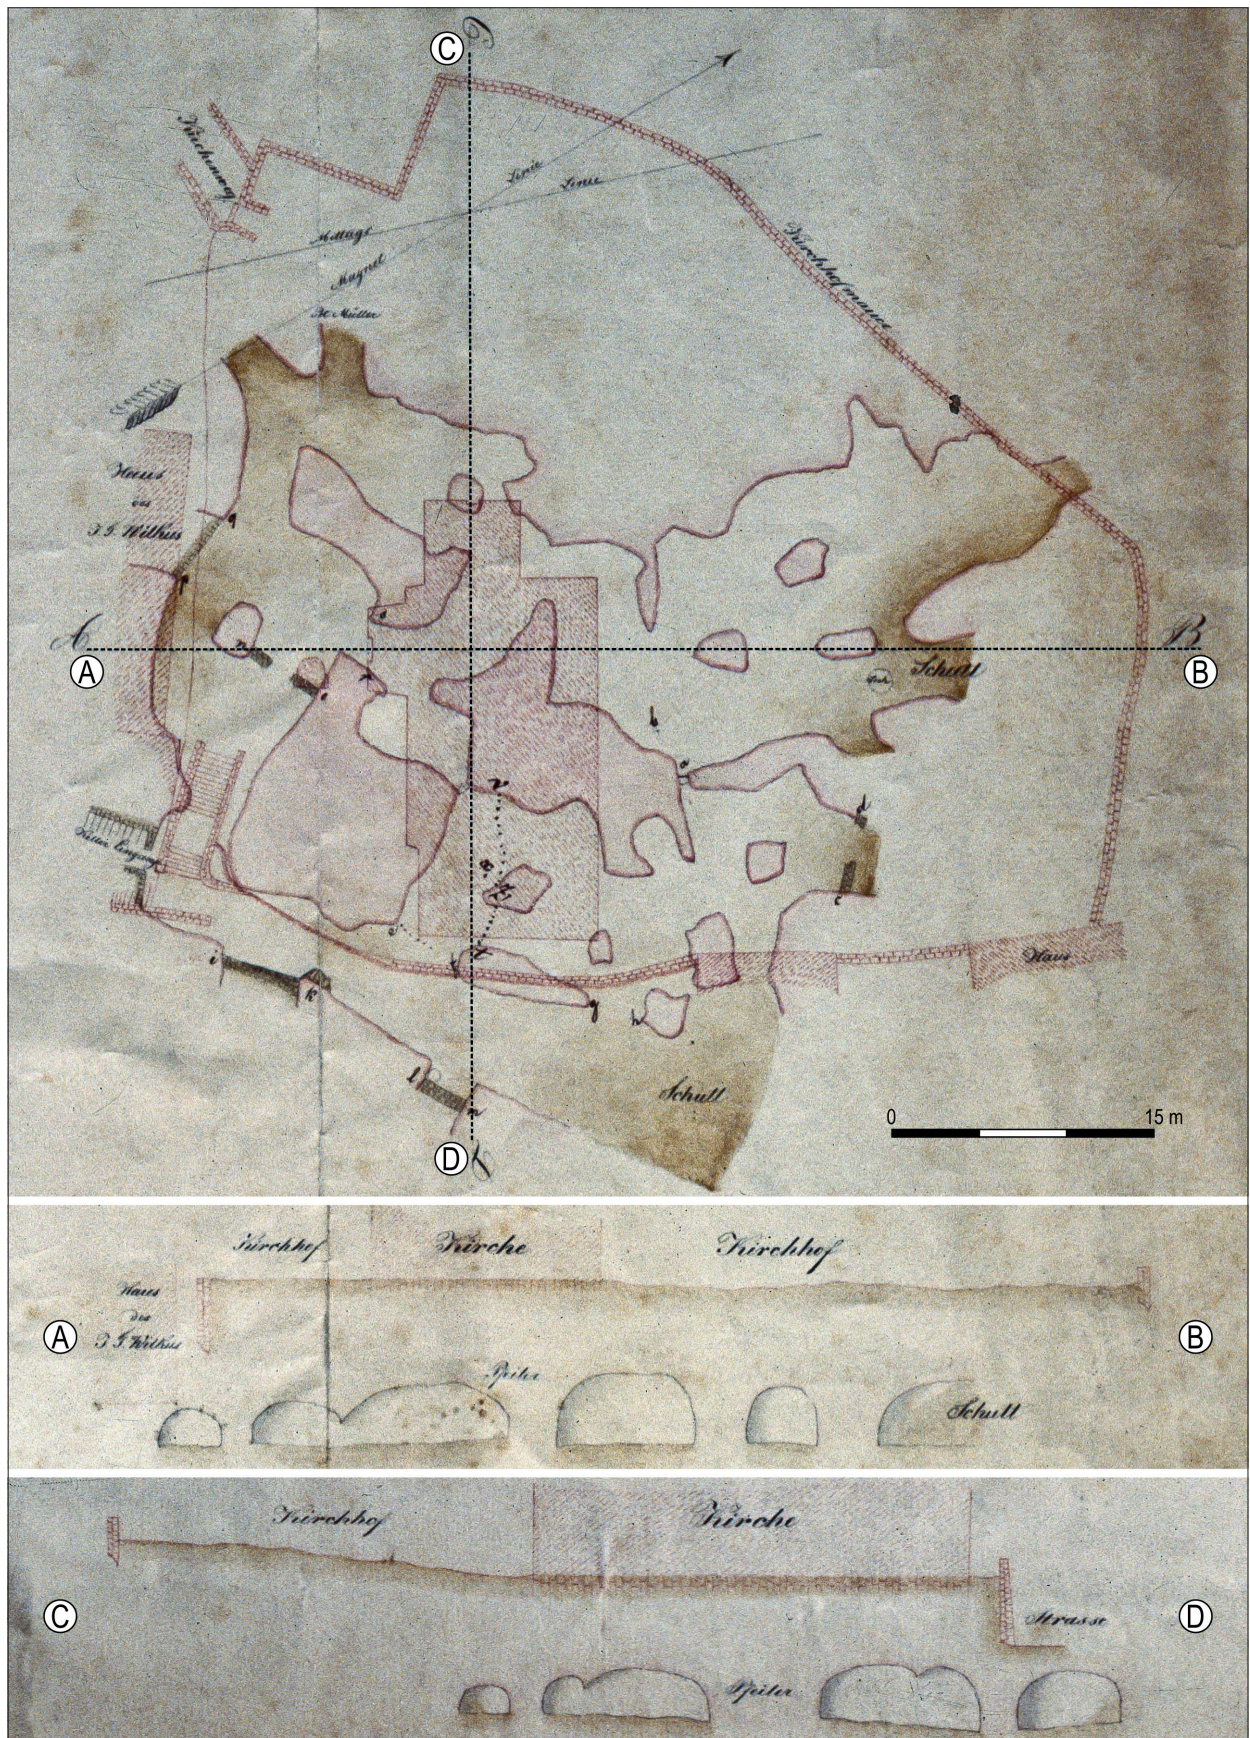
FS 50, Alter Kirchhof. Grundriss und Schnitte von 1855. – (Quelle LHA Ko Bestand 702 Nr. 2192).
